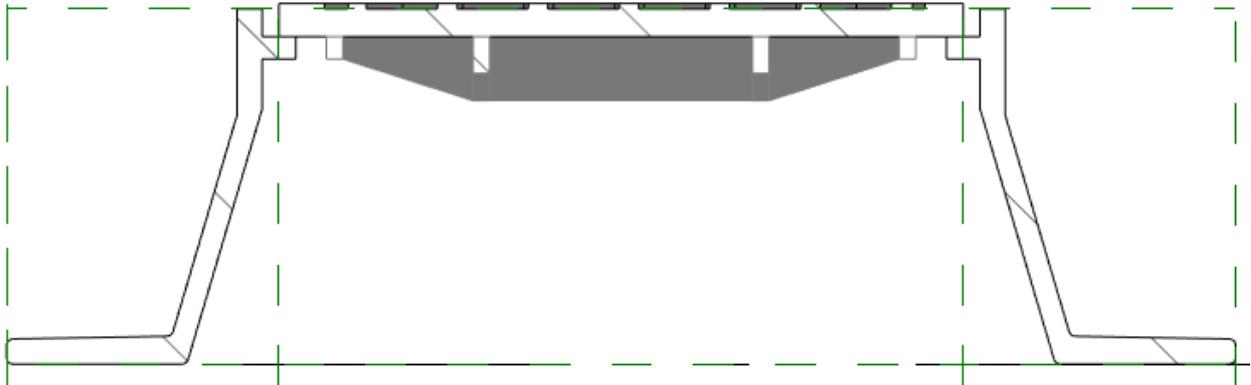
Vista de la sección de corte con estilo visual: Estructura alámbrica.
